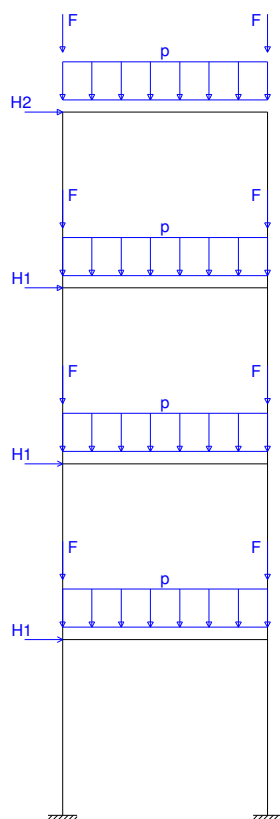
Configuração das acções aplicadas ao PT41
